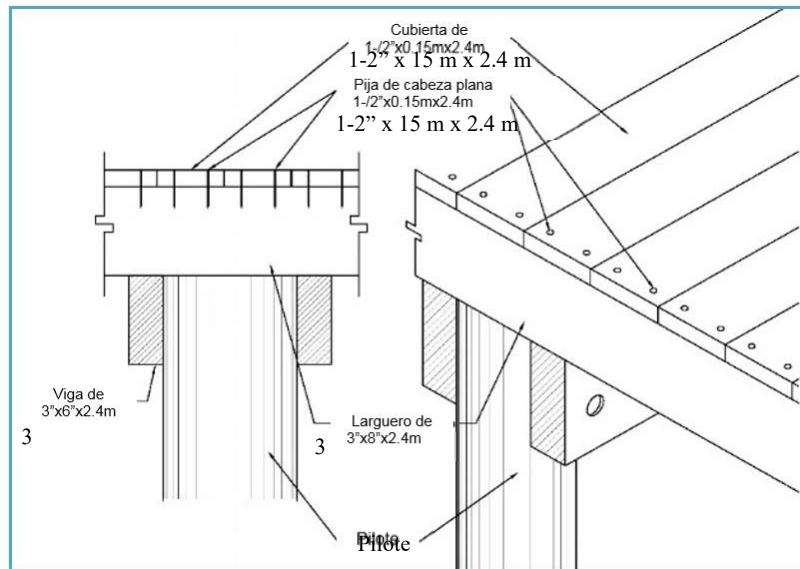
DETALLE DE LA CUBIERTA DE MADERA
